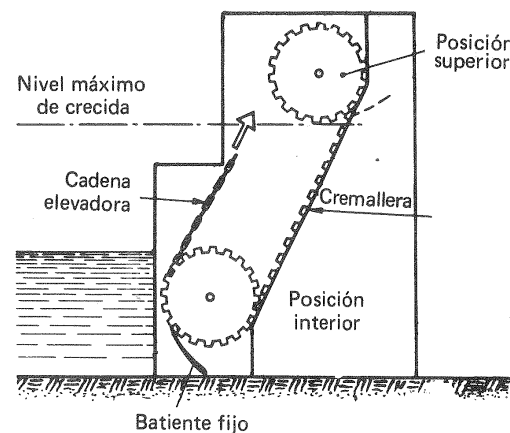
Esquema de una compuerta cilíndrica.
